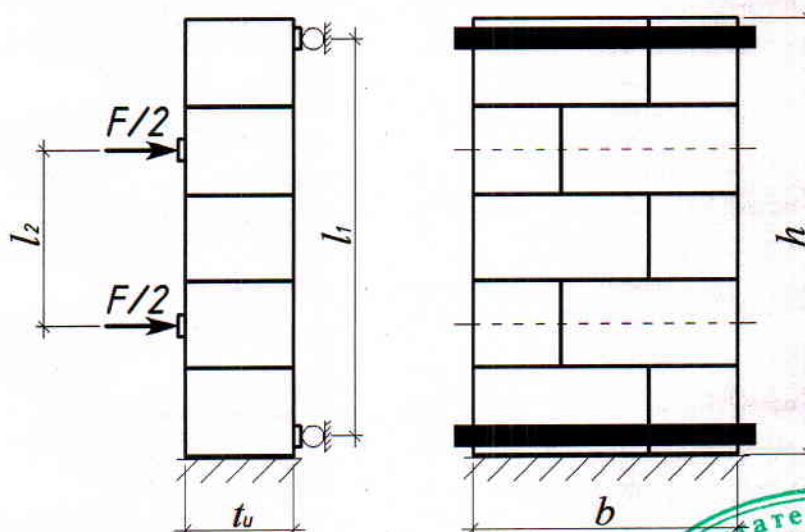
Схема испытаний кладок на изгиб по неперевязанному сечению
